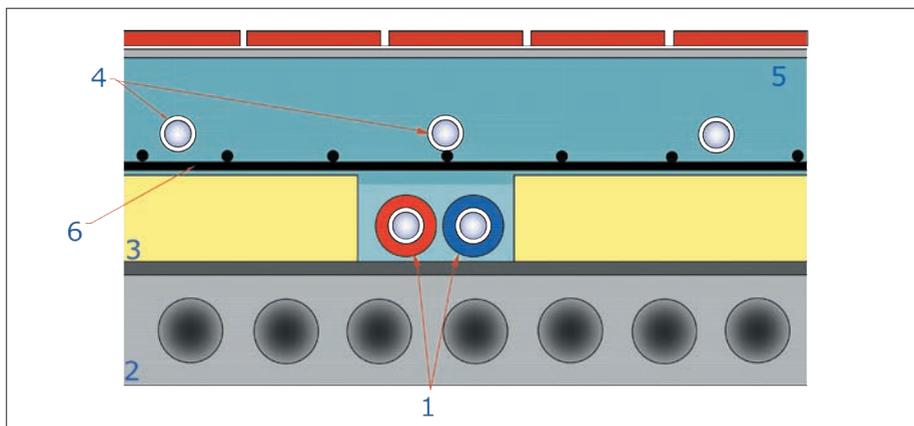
Прокладка трубопроводов других инженерных систем в конструкции тёплого пола
